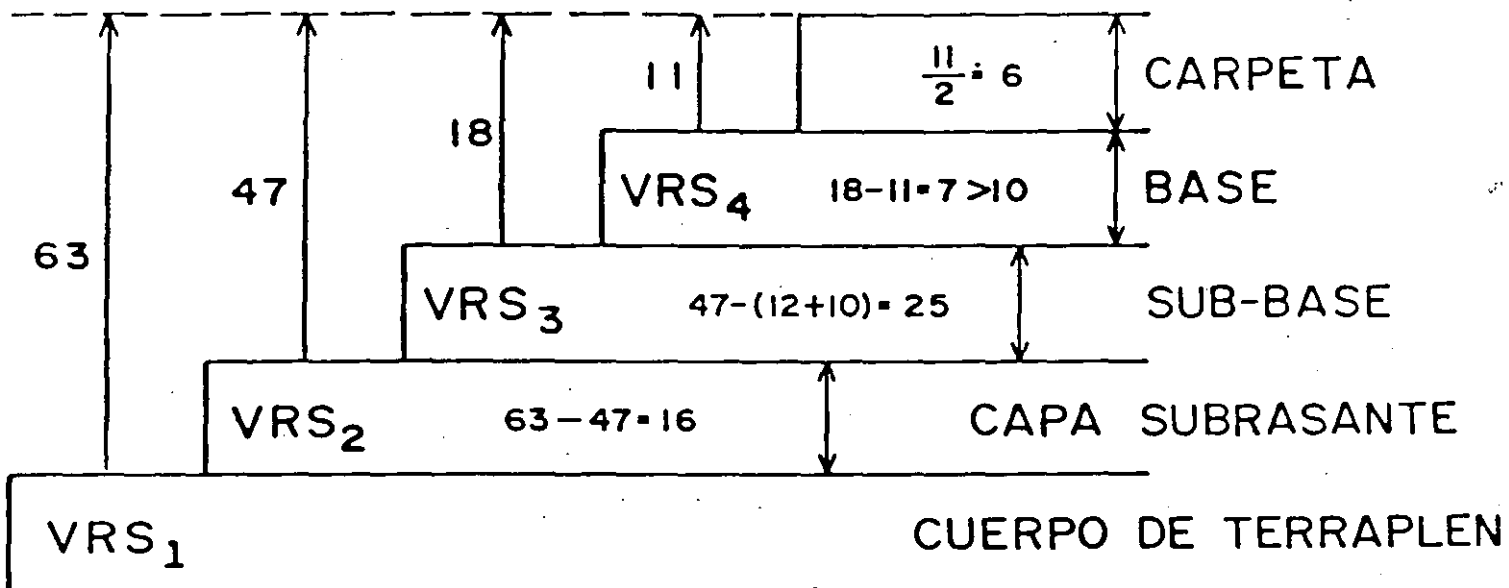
Ejemplo: gráfica para diseño estructural de carreteras con pavimento flexible
